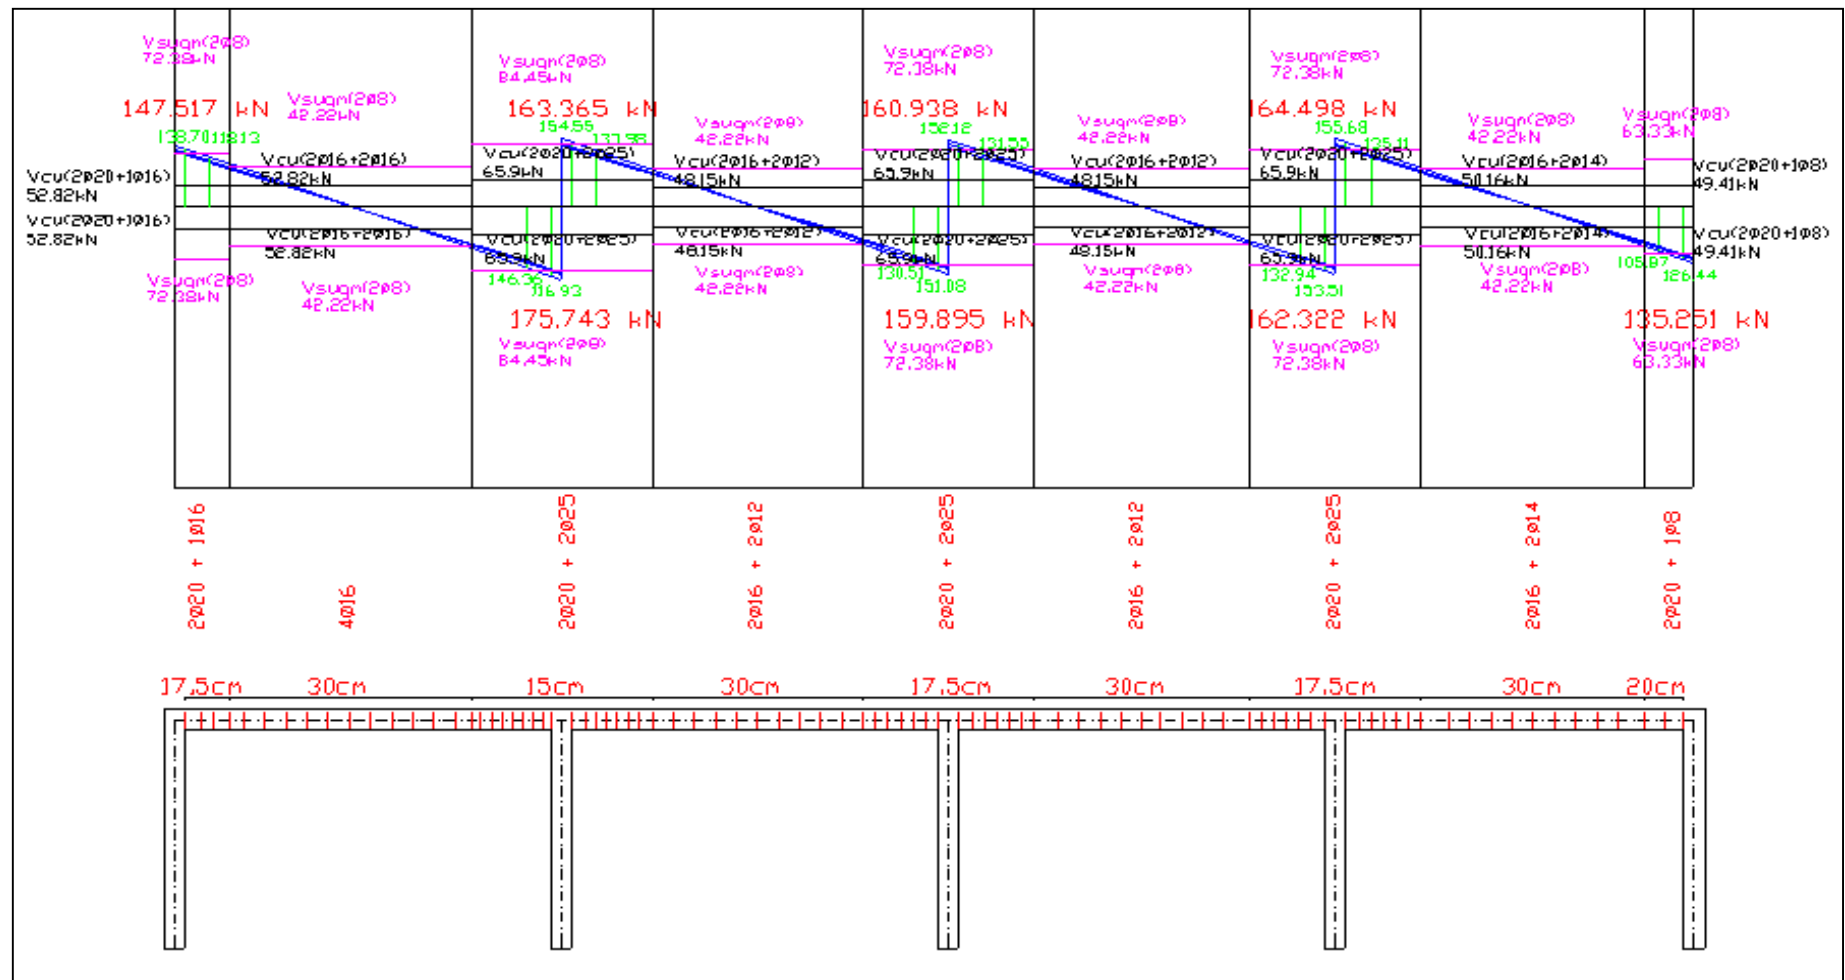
Armado transversal. Fuente, elaboración propia a partir de AutoCAD
